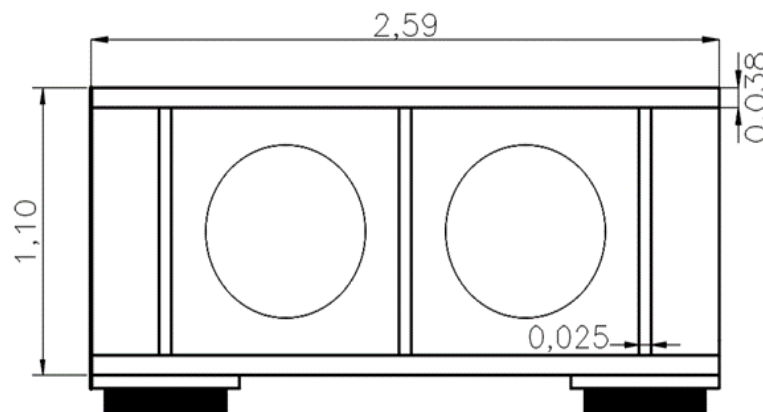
Corte do apoio na ponte Vereadora Ruth Coutinho
